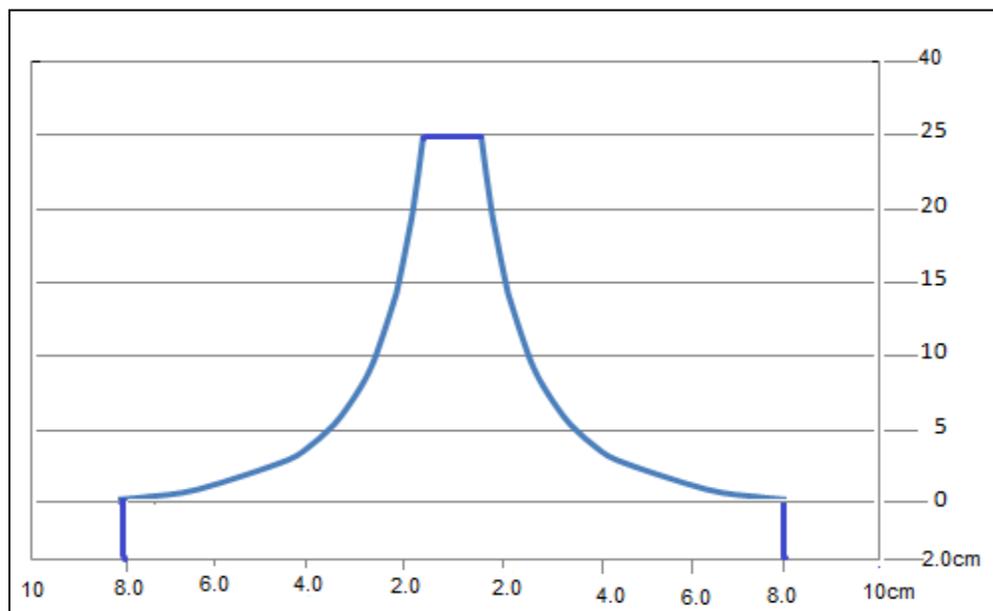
Esquema de construcción del vertedor proporcional tipo “sutró”
